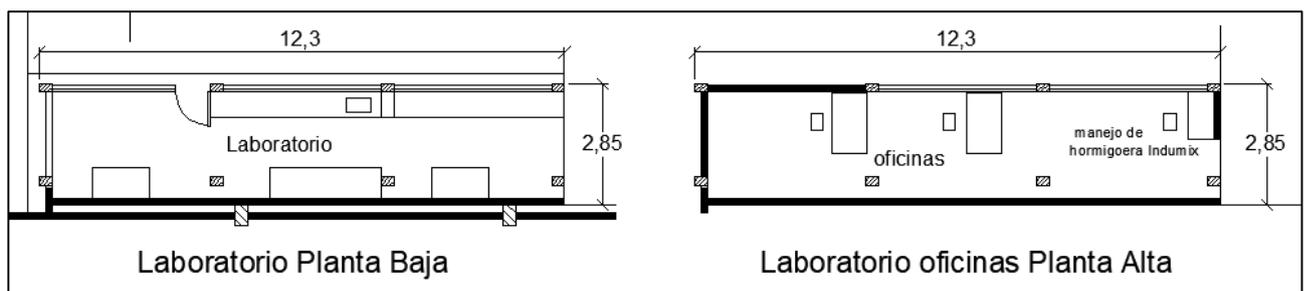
Planos Laboratorio y Oficinas (Preparación de hormigón).
